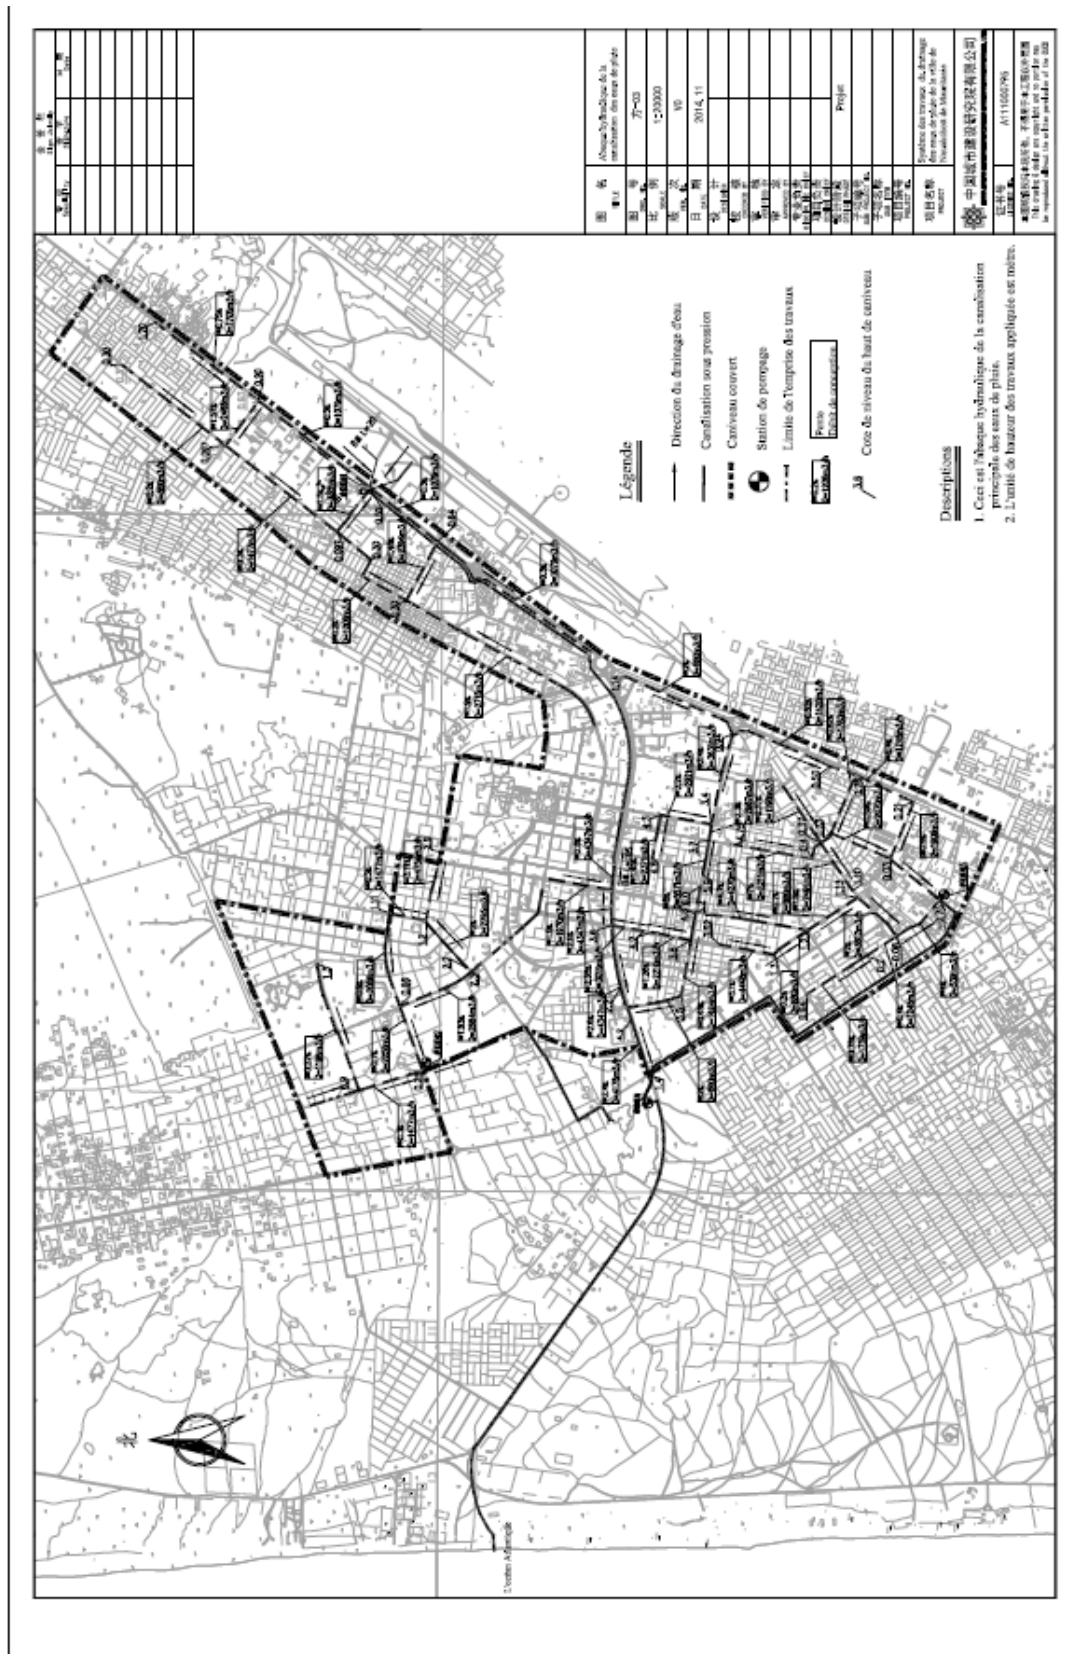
中国实施予定の都市排水プロジェクト平面図
